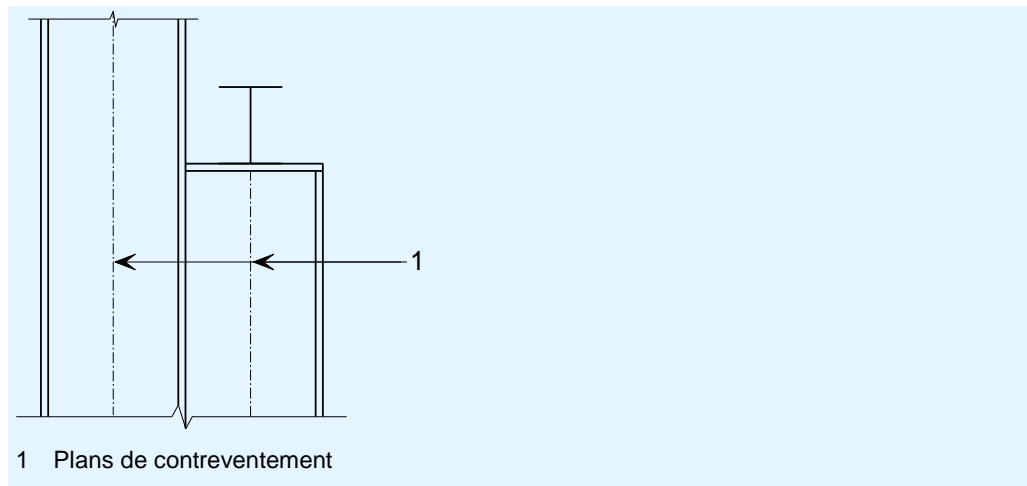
Détail montrant le contreventement additionnel dans le plan de la poutre de roulement
